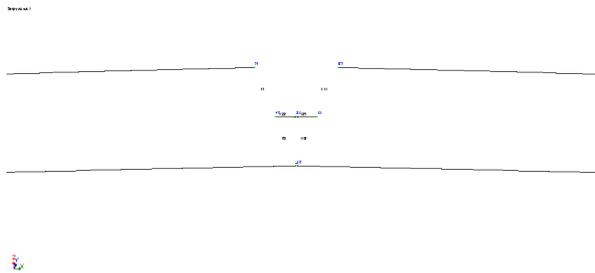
Вузол стирання плит перекриття на ферму в розрахунковій схемі.
